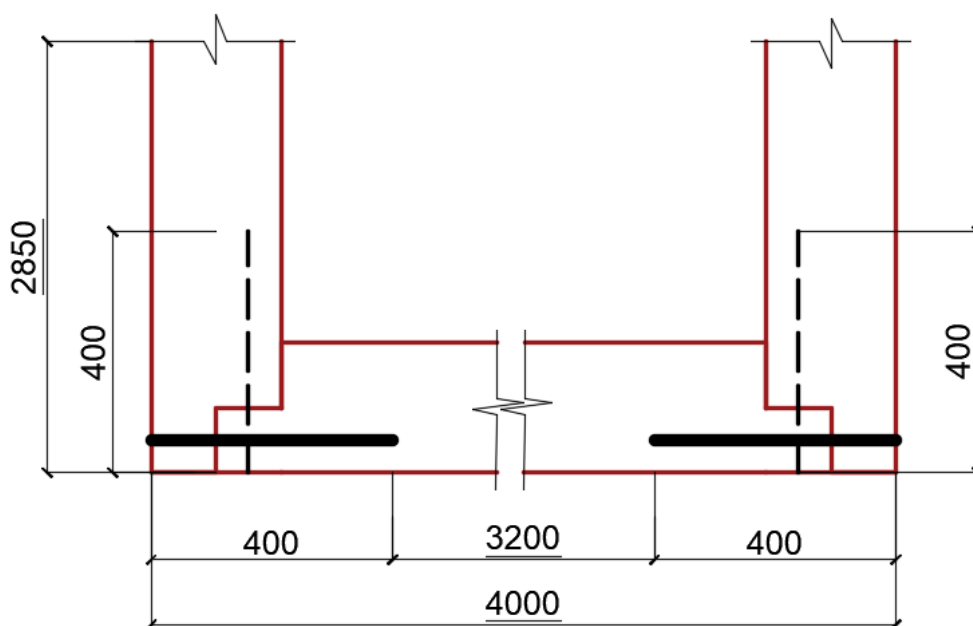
Узловое соединение панелей вид сверху
